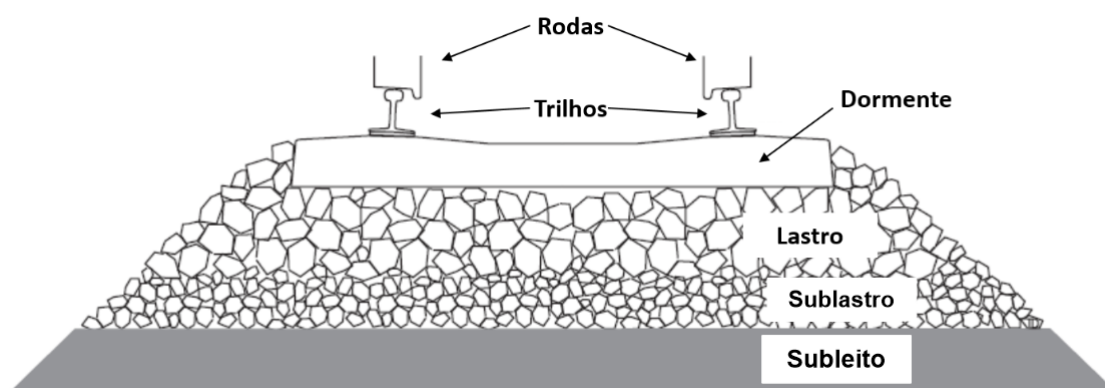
Infraestrutura e superestrutura de um sistema ferroviário. Adaptado de Iwnicki, Björklund e Enblom (2009)
